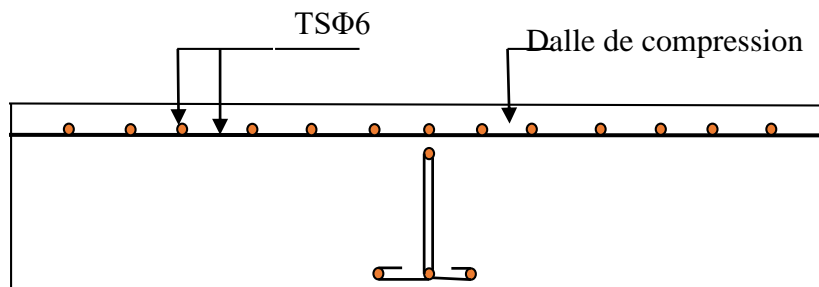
Schéma de ferrailage de la dalle de compression.
